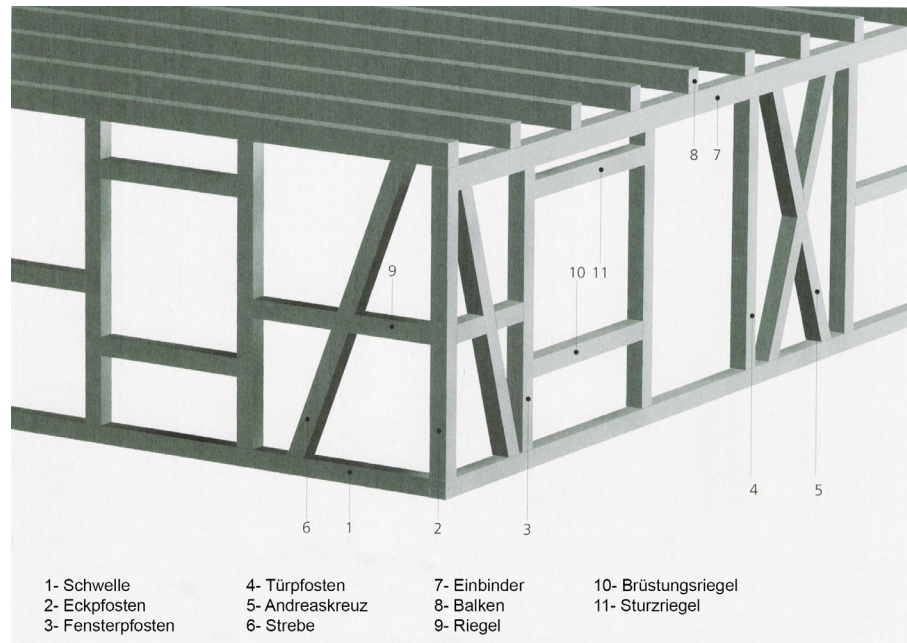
Fachwerkbau 02. Kolb 2008, 56
